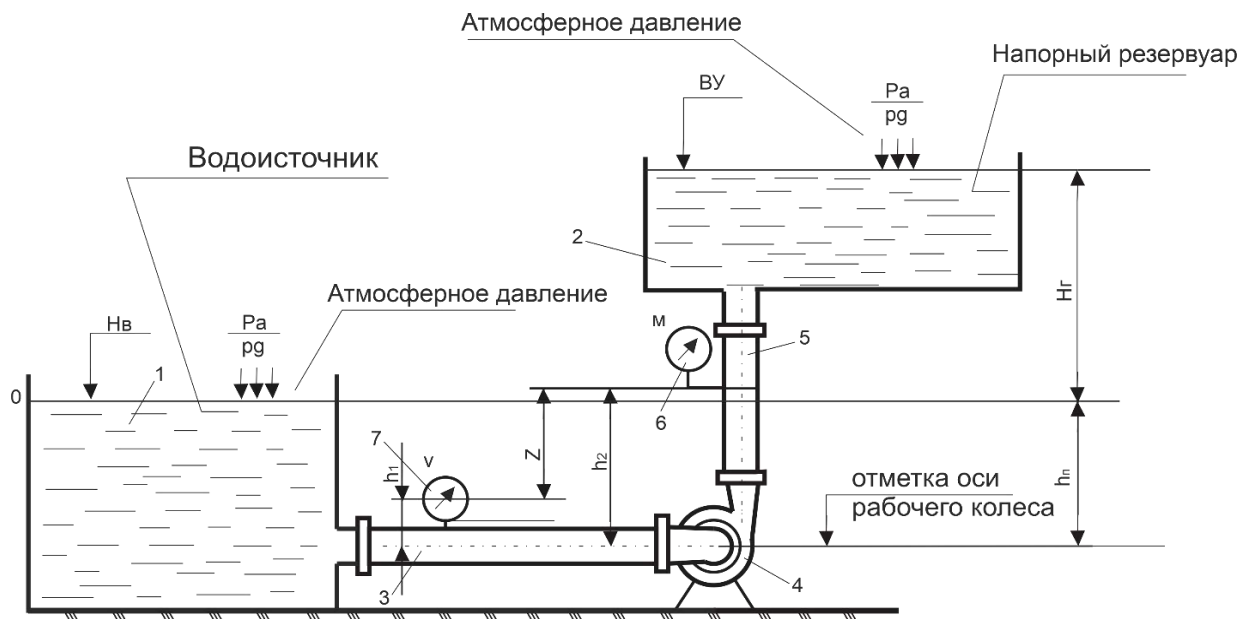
Монтажная схема центробежного насосного агрегата с отрицательной высотой всасывания и подачей в напорный резервуар
